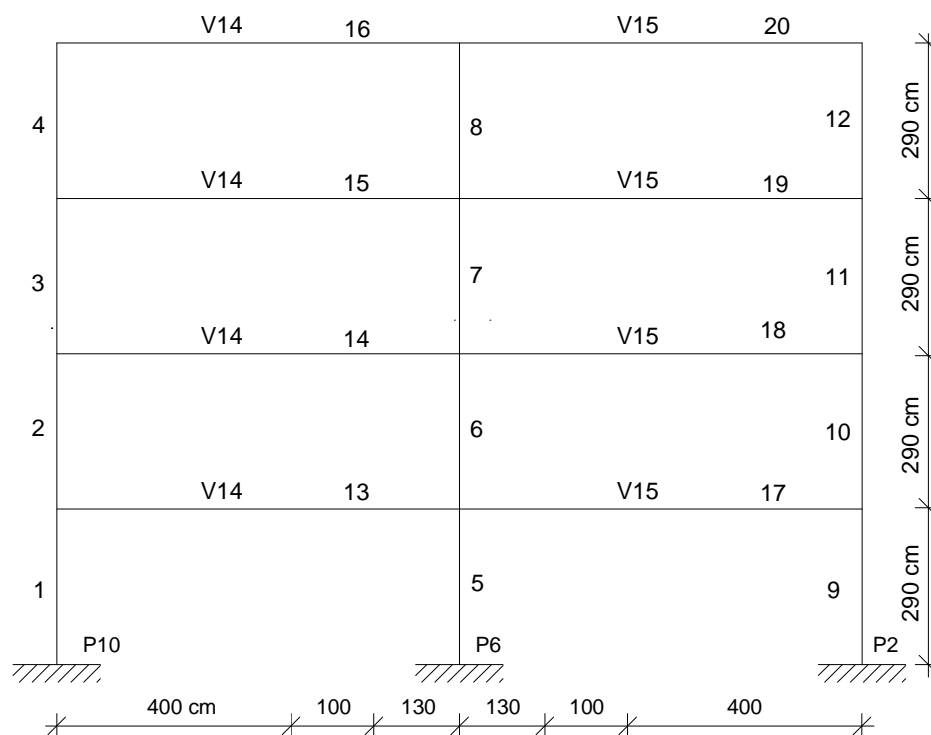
Numeração das barras do pórtico longitudinal – Caso B1.
